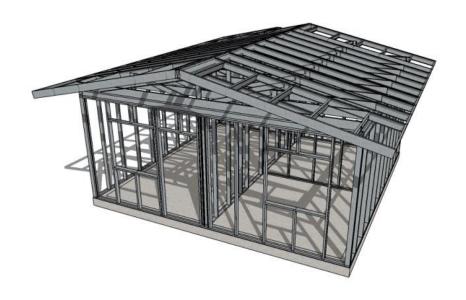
Fase 3: Fijación e instalación de estructura de cubierta. Fuente: Elaboración Propia.
